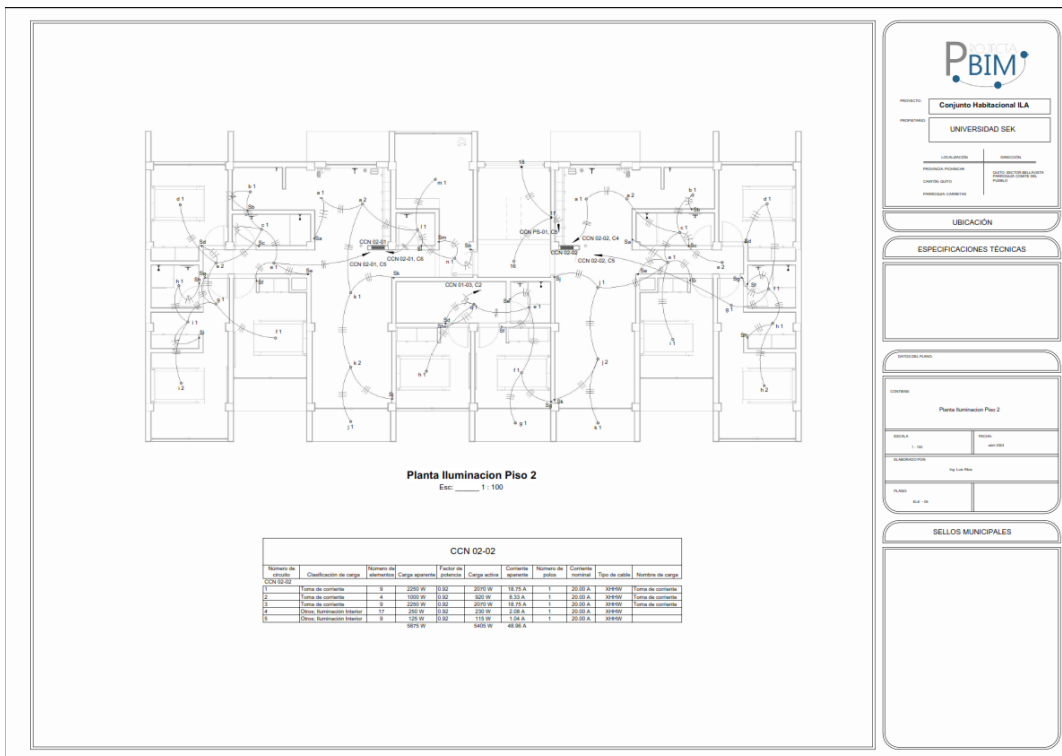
Plano eléctrico Iluminación Piso 2 B1
